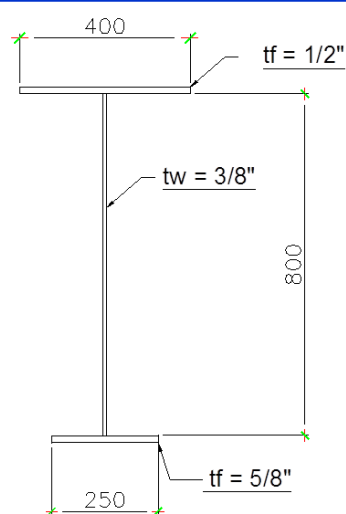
Perfil doble “T” “Armado” de Alas Desiguales o Asimétrico construido por chapas de acero laminadas en caliente
